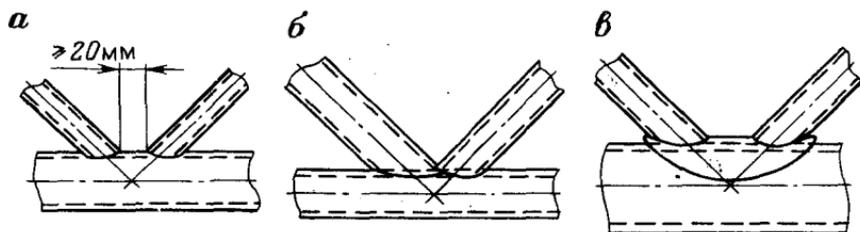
Сварка бесфасочных трубчатых стержней
